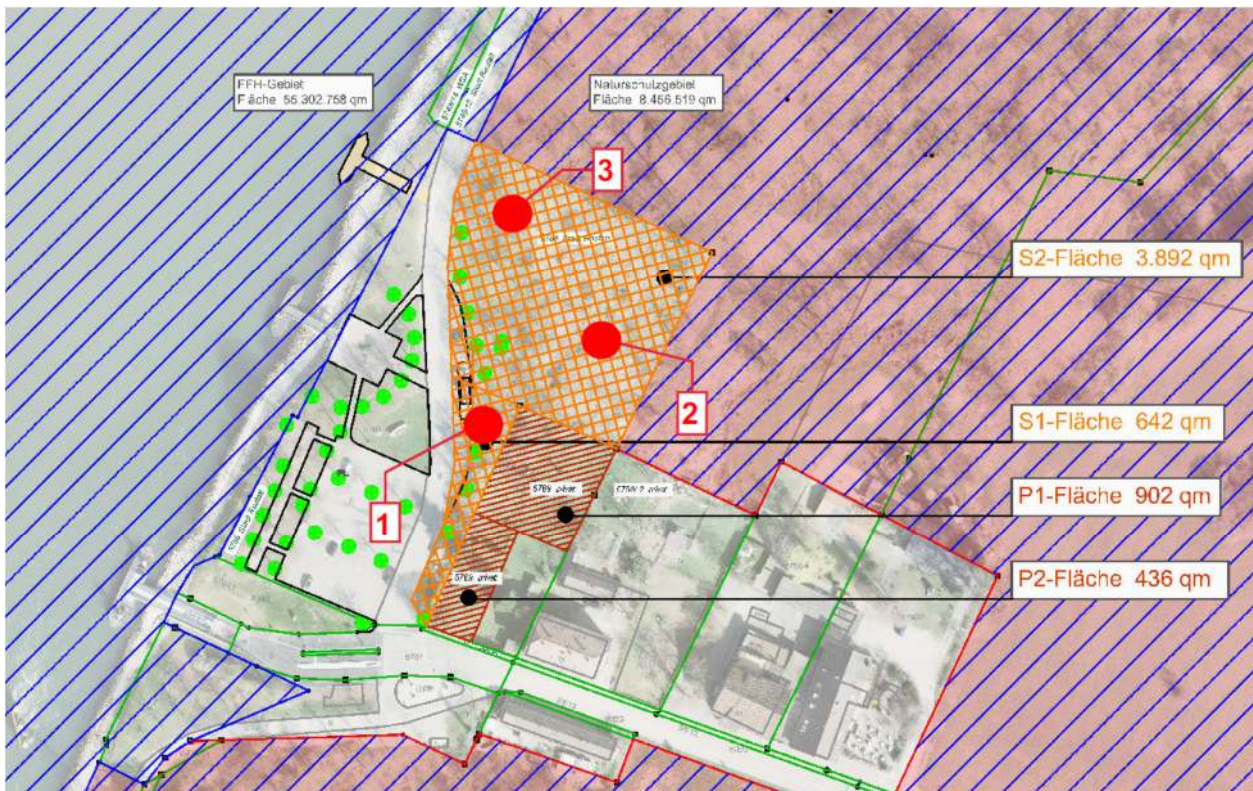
Baugrunduntersuchungen Mailänder Consult MIC (08.06.2018)
